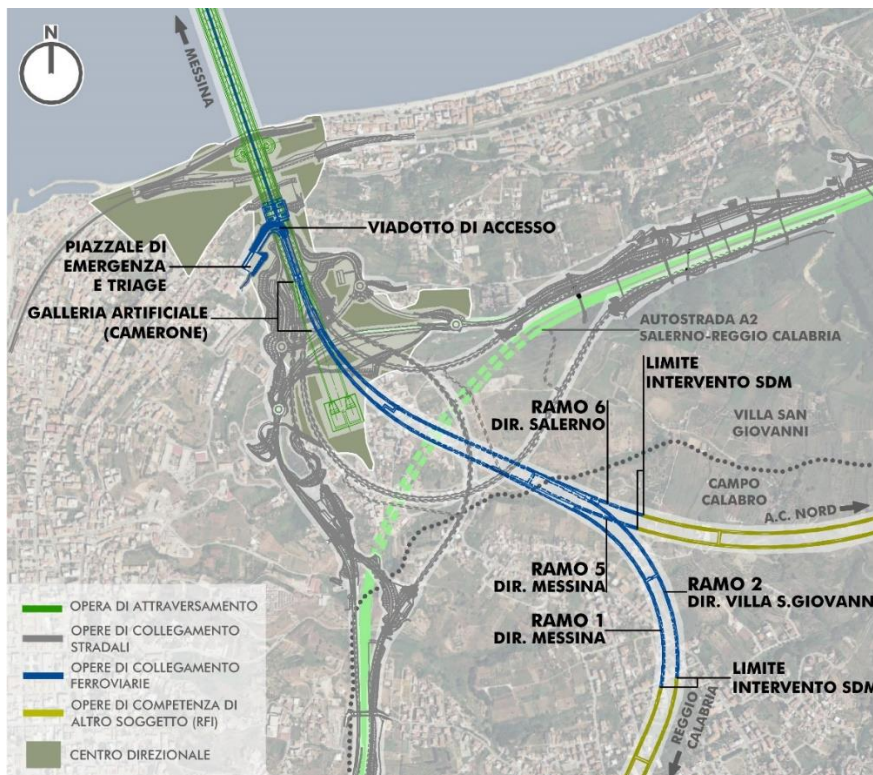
Stralcio planimetrico con indicazione dei rami costituenti i collegamenti ferroviari di progetto sul versante Calabria
